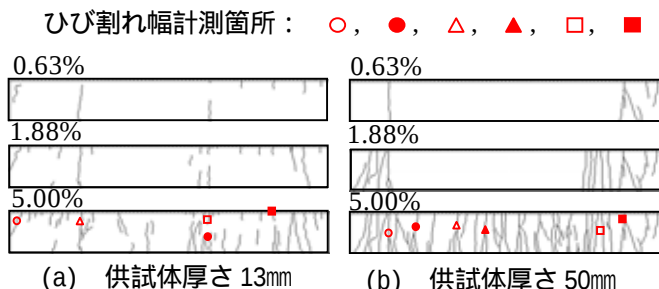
各ひずみ段階におけるひび割れ発生状況
